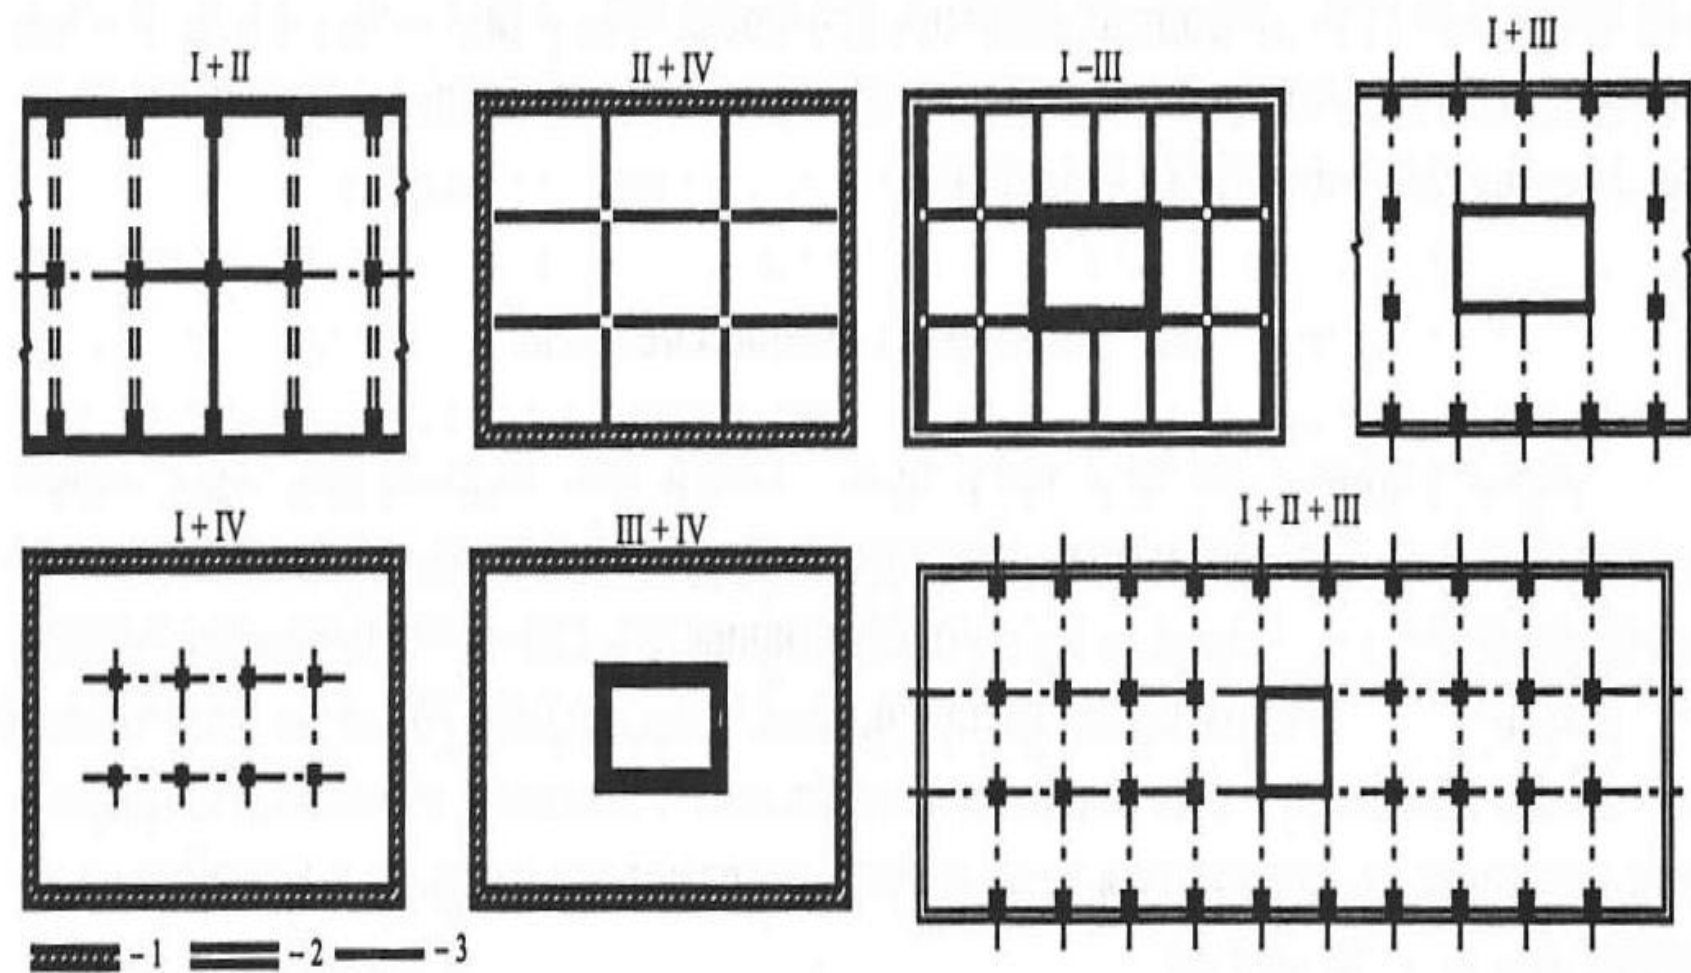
Комбинированные конструктивные системы: 1 – наружные несущие стены; 2 – то же, несущие; 3 – несущие внутренние стены
